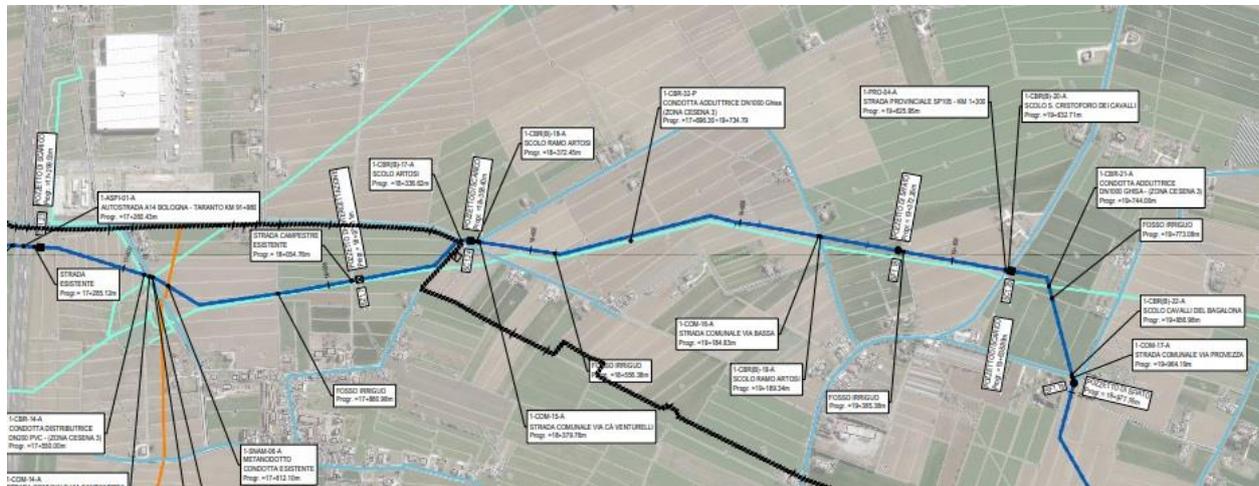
la sezione del tracciato posta in parallelo all'esistente condotta del sistema CER
